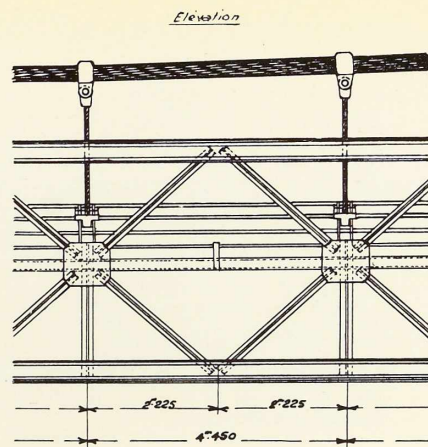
Détail d'élévation montrant le câble, les suspentes et la poutre de rigidité.
